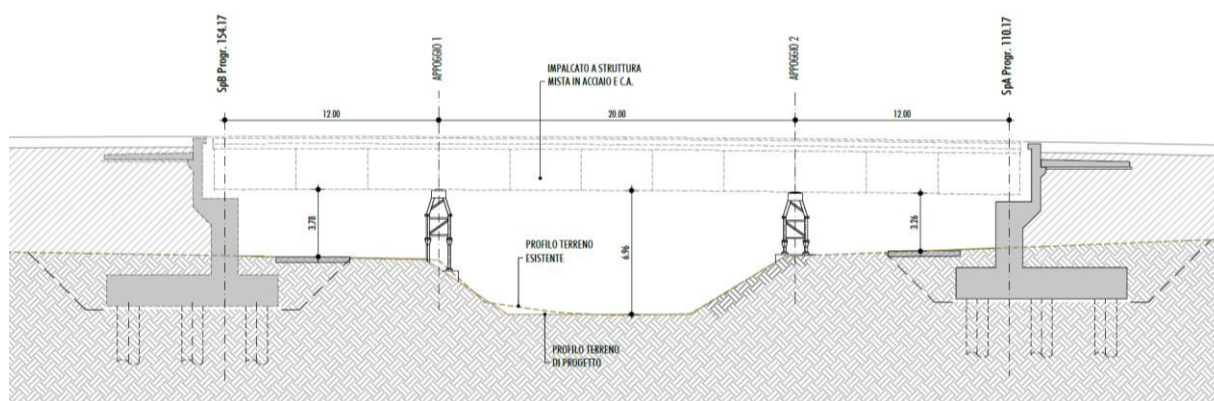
SEZIONE IN ASSE STRADA (VISTA DA MONTE) DURANTE LA FASE DI CANTIERE CON GLI APPOGGI PROVVISORI
